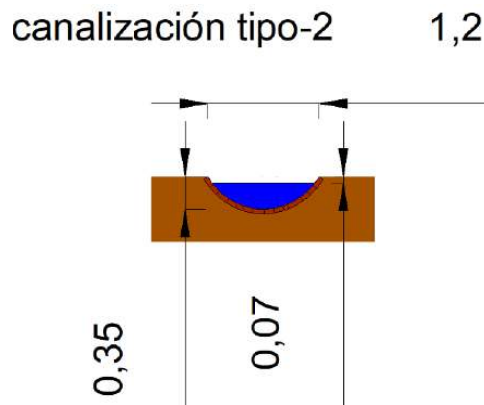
Canalización sobre talud (canal bajante) para descarga en P2. (m).
